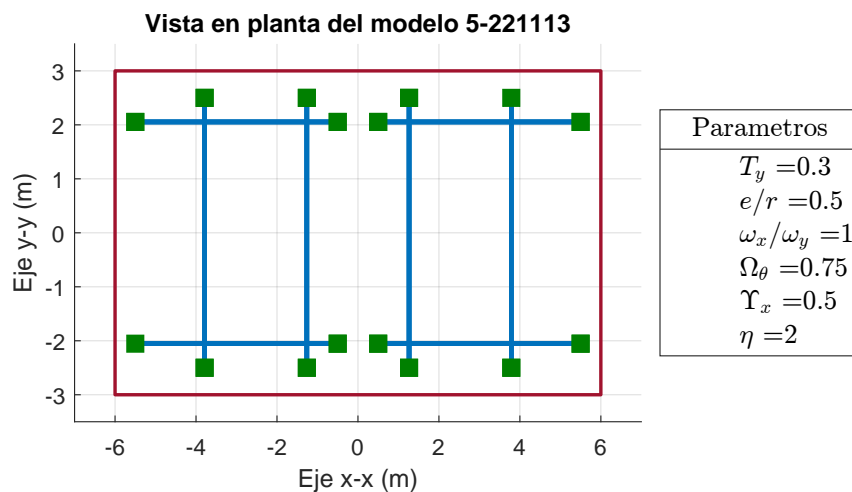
Esquema de la planta estructural para el modelo 5-221113.
